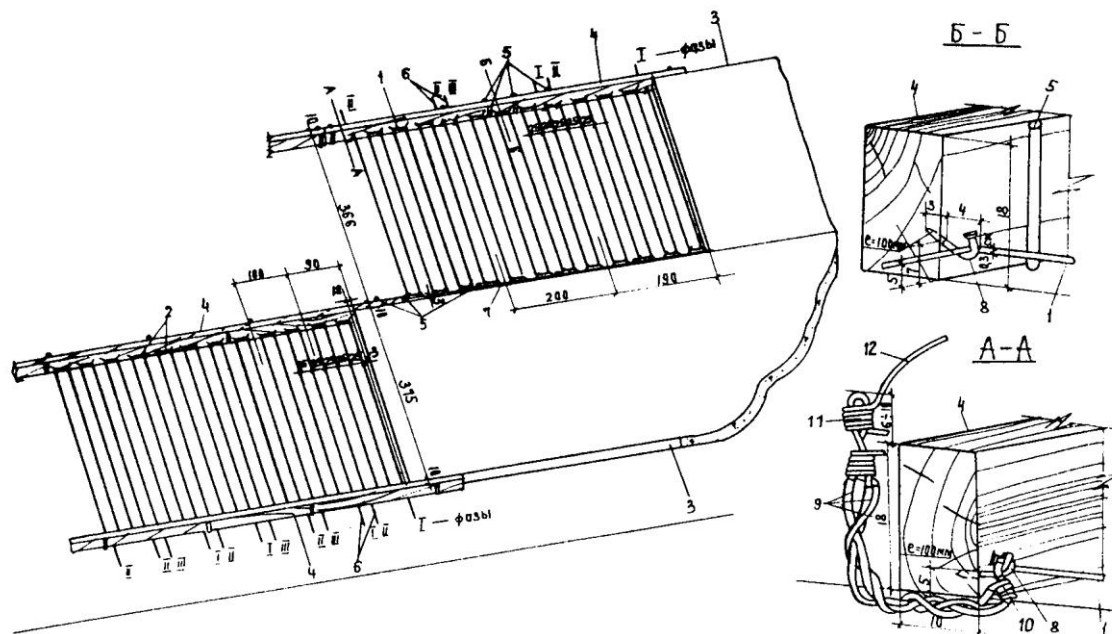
Бетонные покрытия (полы, площадки, дороги) толщиной  $15 \div 20$  см:
